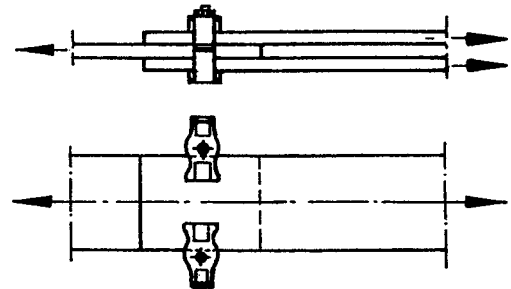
Zwei Reibflächen zwischen den durch Trägerklemmen zu verbindenden Bauteilen:
